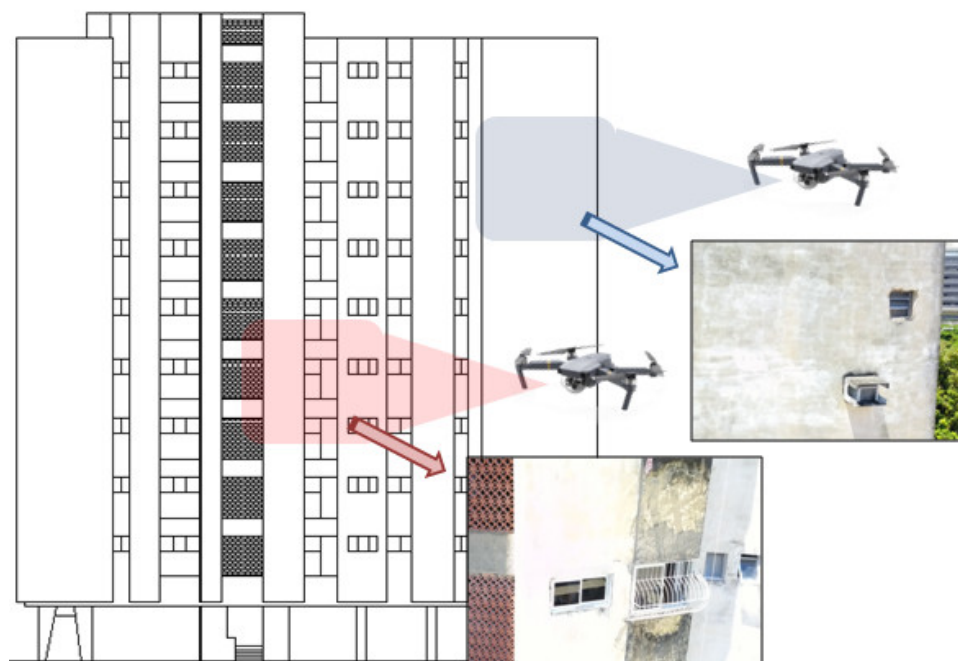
Ilustração da utilização do VANT na fachada oeste da edificação
